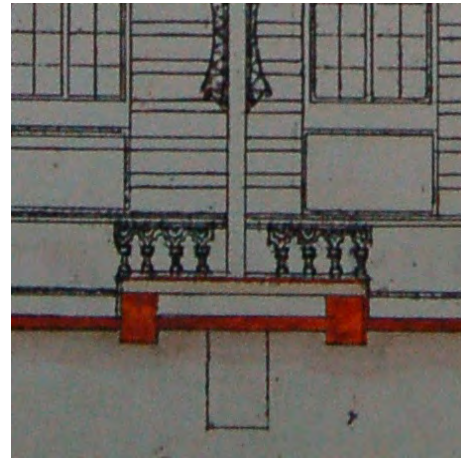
Planmaterial Längsschnitt Ausschnitt mit eingezeichneter Estrade
